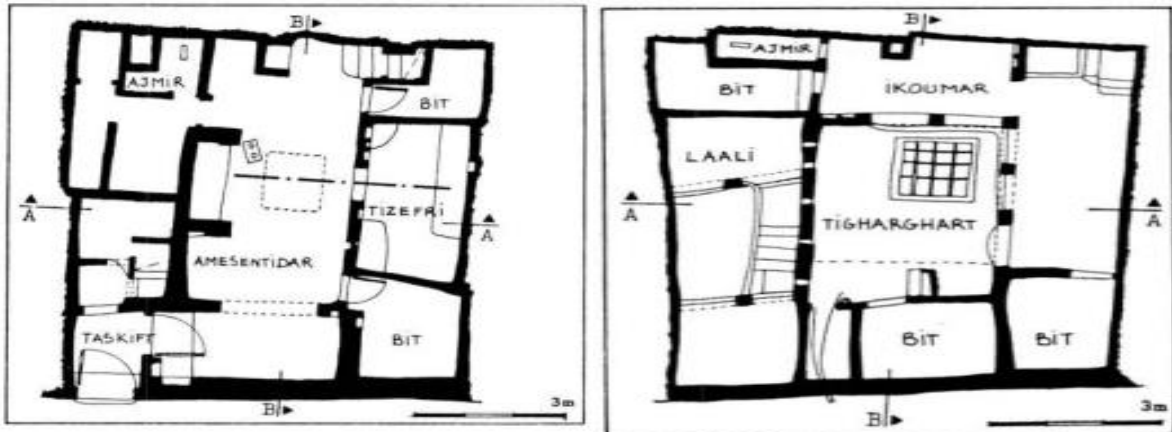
Plan rez de chaussée Fig 1-6 : Plan d'étage
